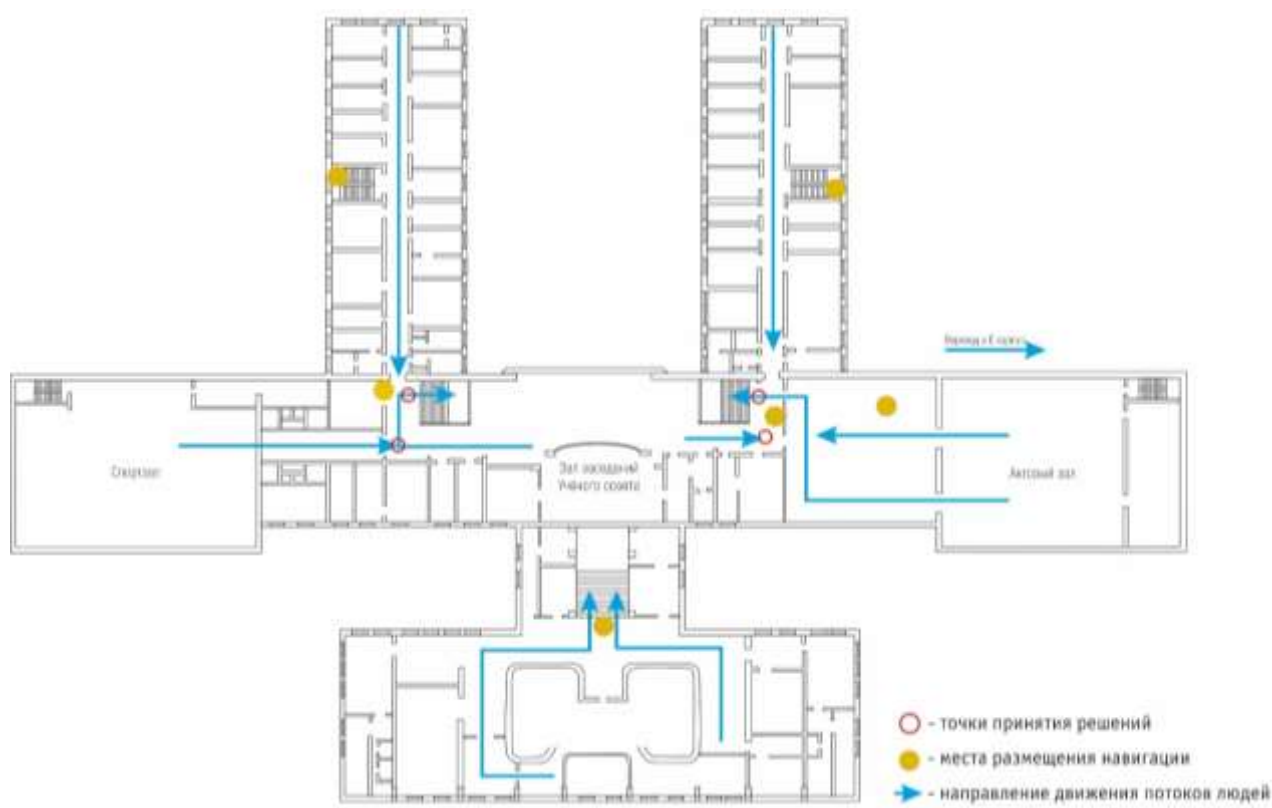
План 2 этажа главного корпуса ОмГТУ
